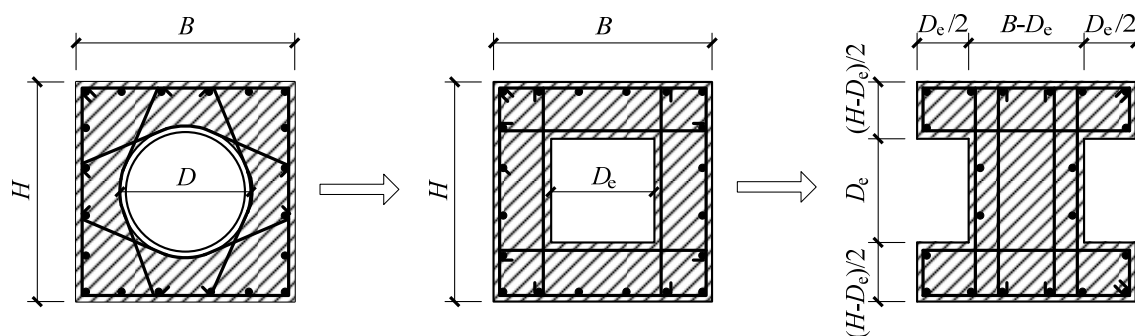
叠合柱管外钢筋混凝土等效工字型截面
